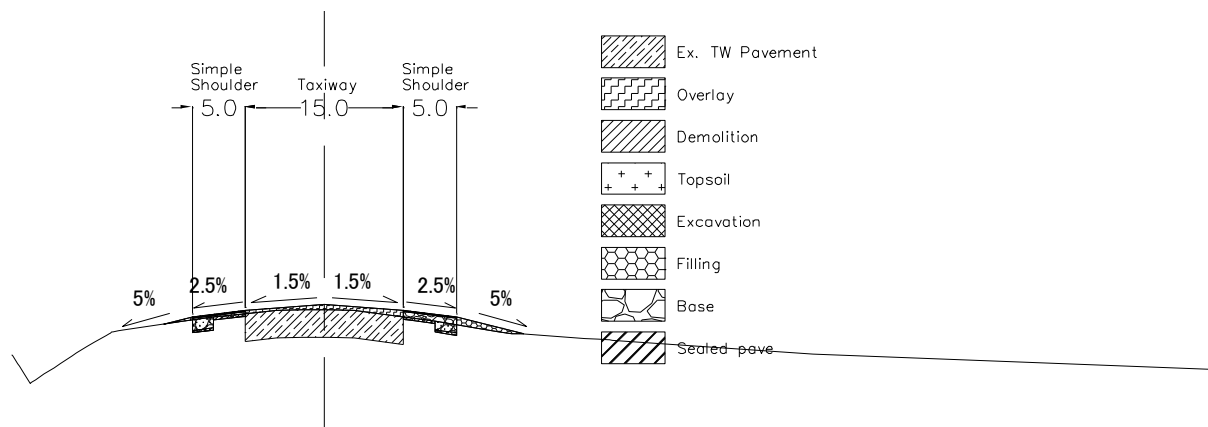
誘導路標準断面図（拡幅なし）
